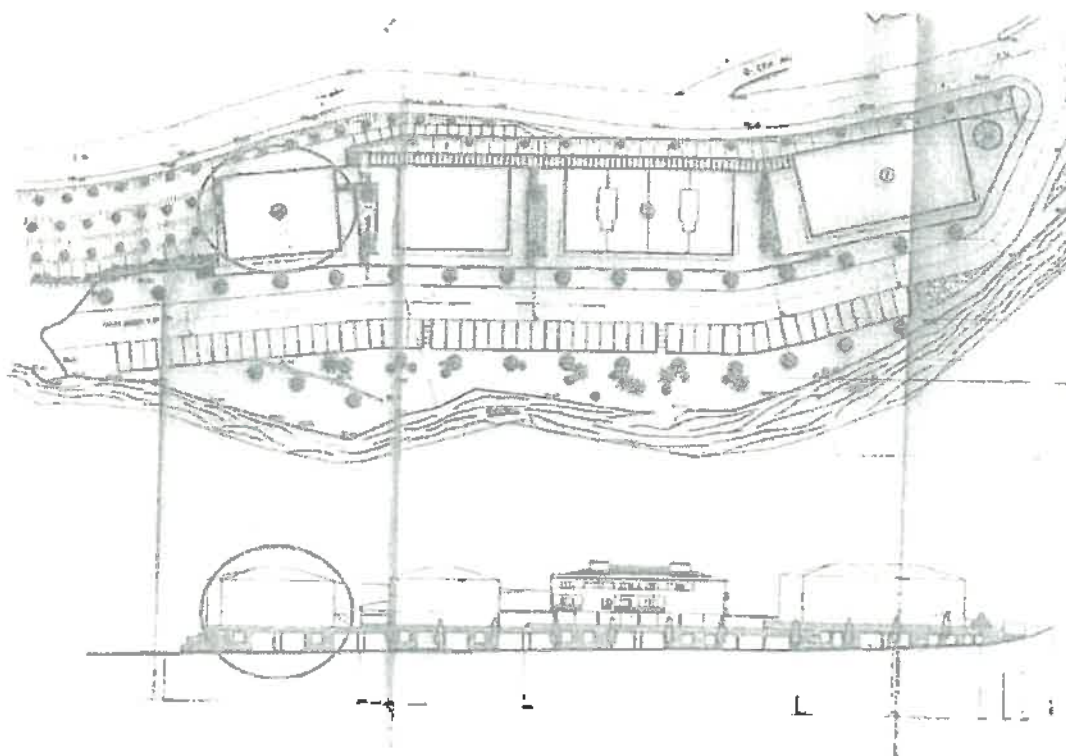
Extrato da planta do pretense loteamento, com LOTE 4 assinalado
